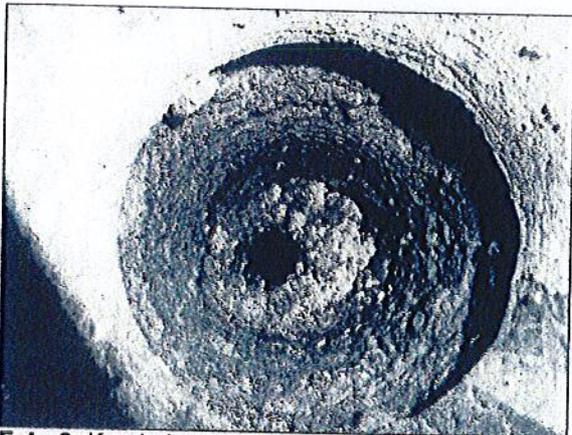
Kernbohrung Gebrauchtwagen-Ausstellungshalle
